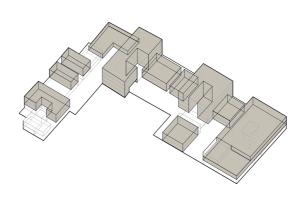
Axonometría de ubicación de vivienda Fuente: Autores, 2022
